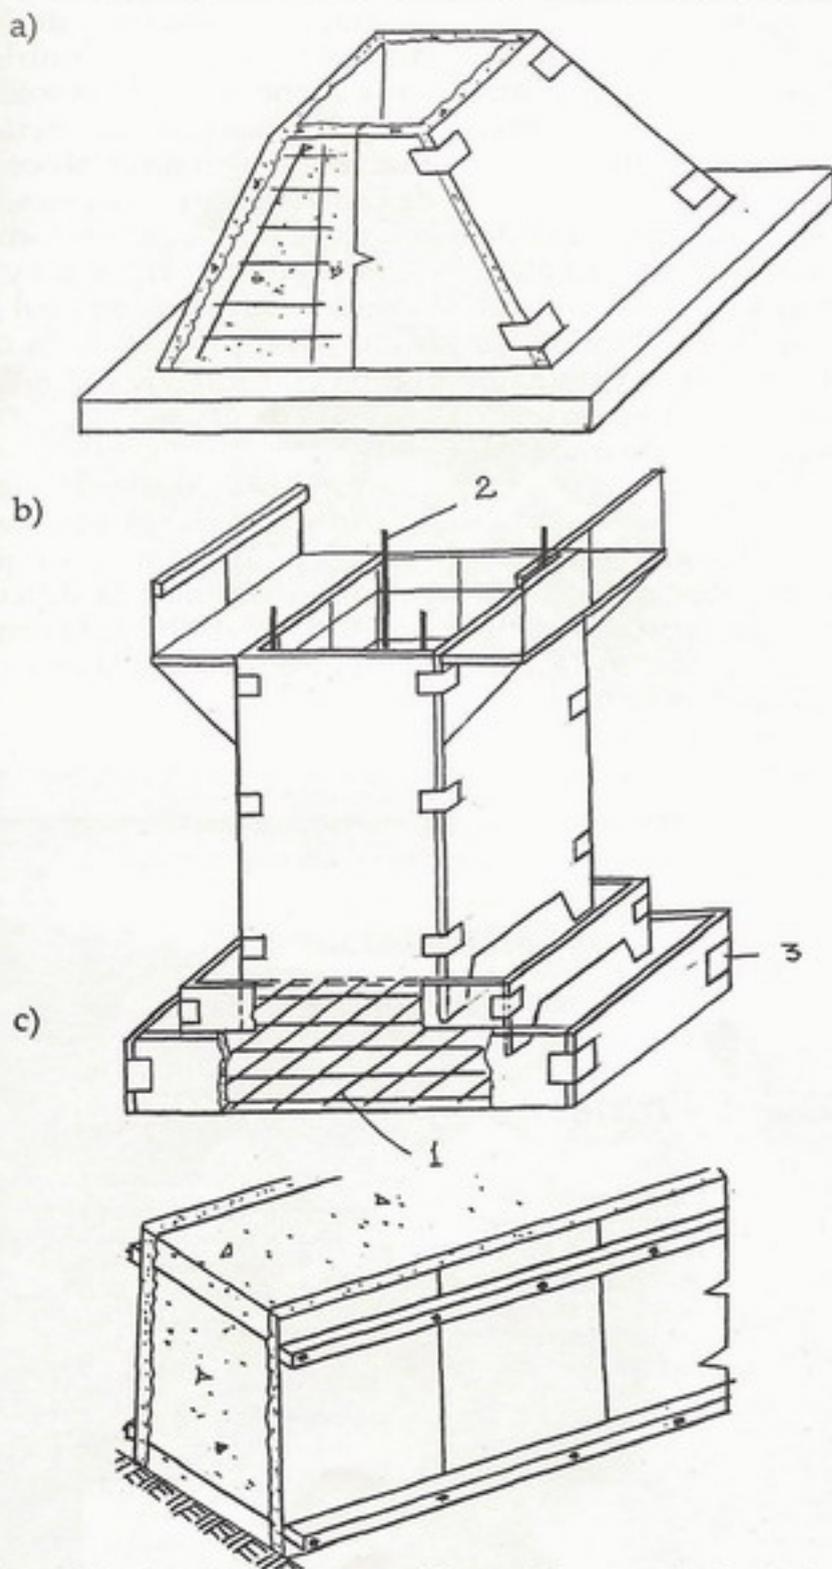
a) Cimiento en forma de trapecio; b) Columna; c) Pared masiva - 1) Malla del cemento; 2) Armadura portante; 3) Platinas metálicas
